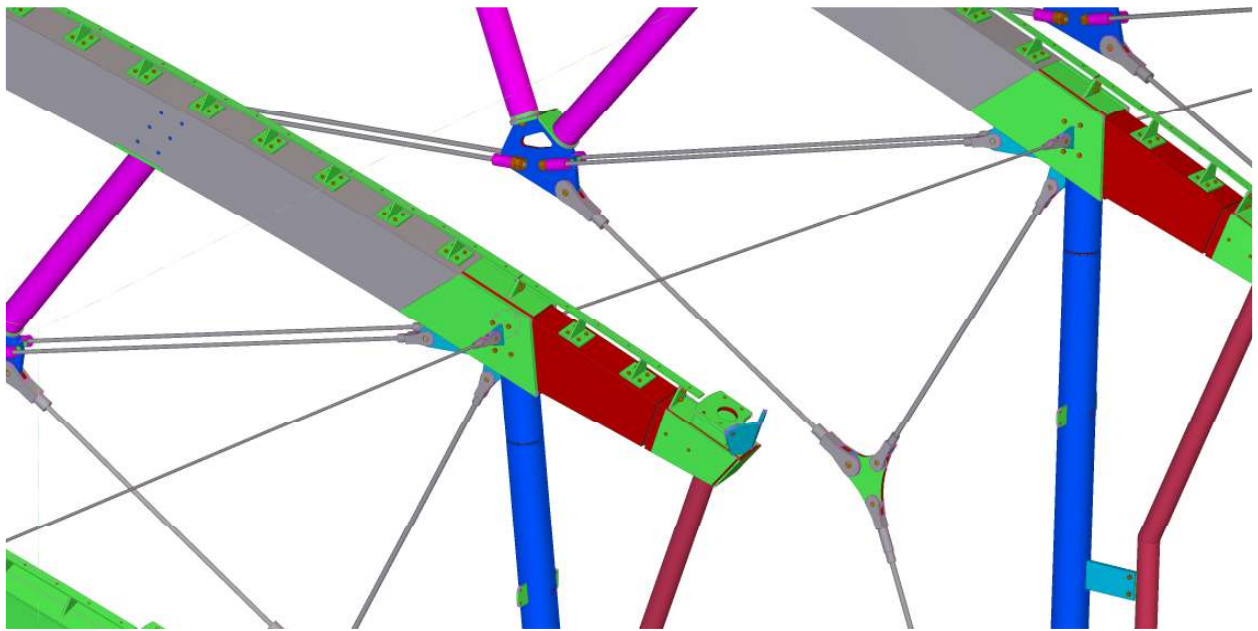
und 6 Konstruktionseindrücke, zugehörige Detailnachweise PSS
